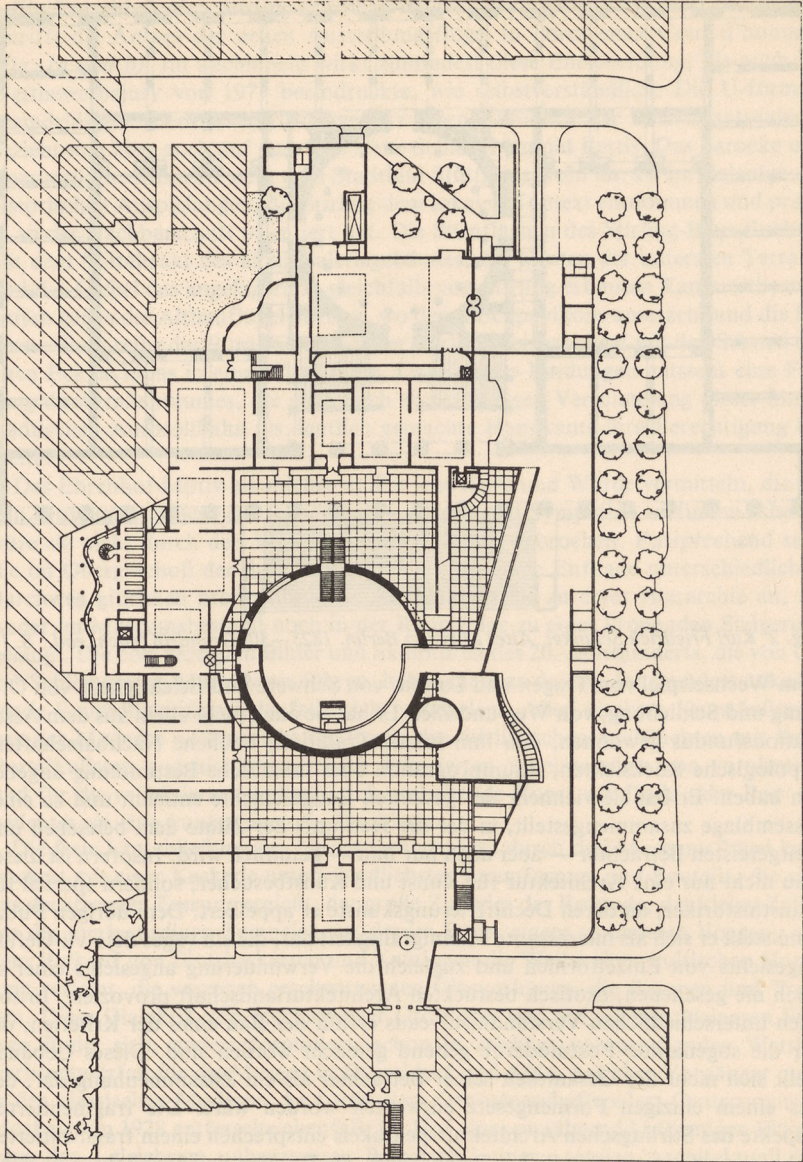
Neue Staatsgalerie Stuttgart, Grundriß Obergeschoß (nach: ebd., S. 19)
